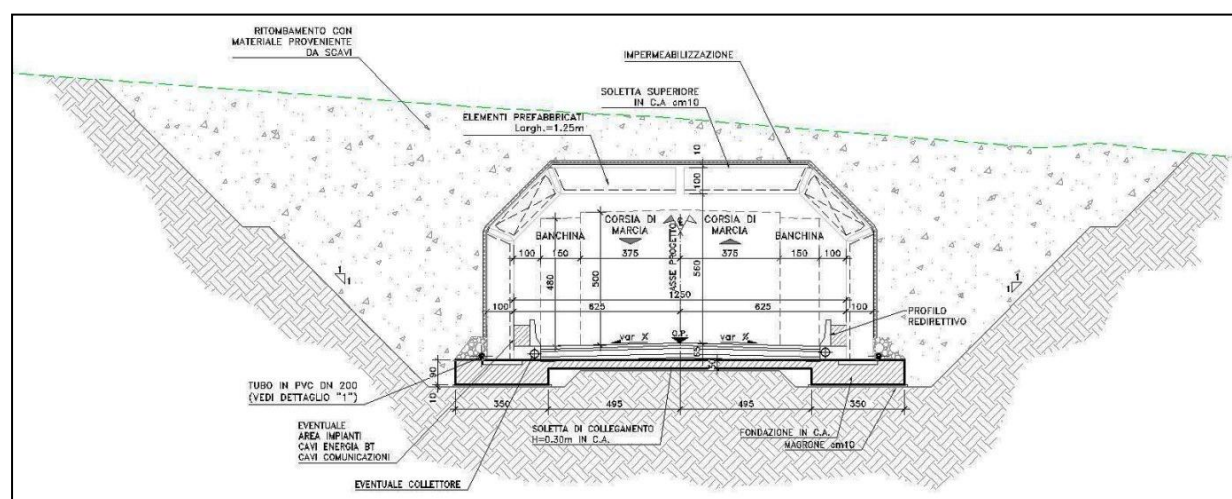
Sezione tipo C1 in galleria artificiale.
